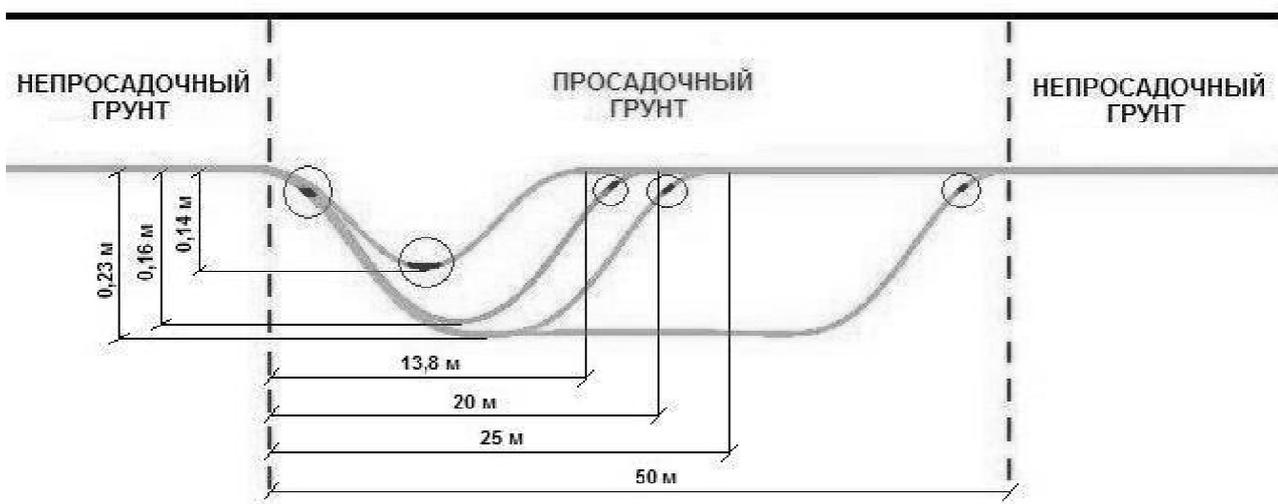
Схематичное изображение модели участка трубопровода при просадках грунтов основания. Места возникновения недопустимых напряжений в трубе выделены окружностями. Масштаб осадки грунта 50:1
